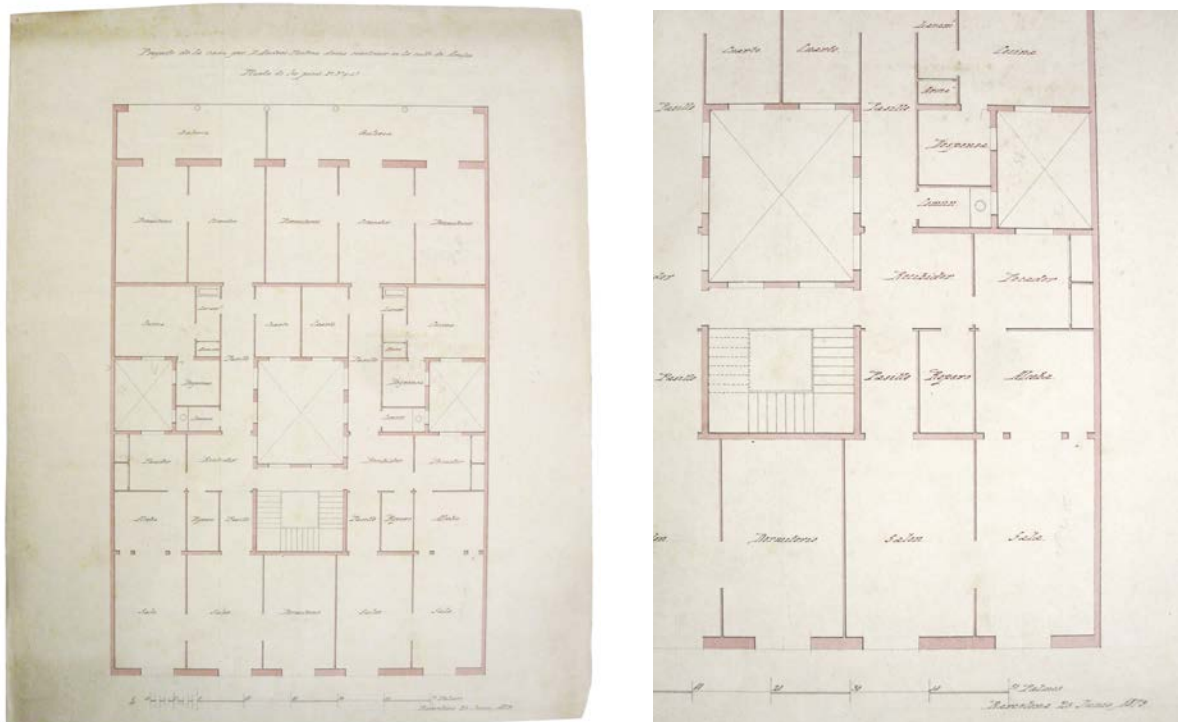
i Fig. 80. Plànol de planta dels pisos 2n, 3r i 4t (esquerra) i detall del plànol (dreta) (Andreu Ventosa, arquitectes Bassegoda, 1879). Font: AHCOAC H115/H/7/364.12.
